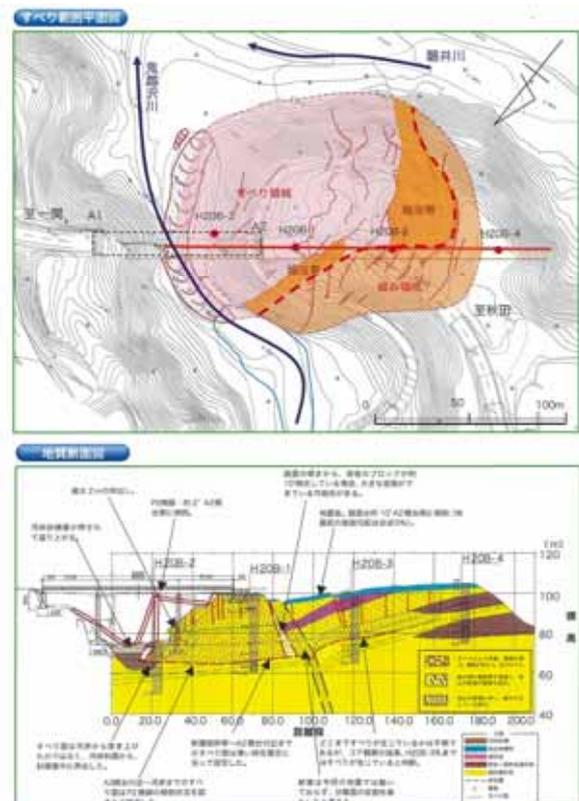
祭時大橋の地すべり平面図と地質断面図<sup>2)</sup>
